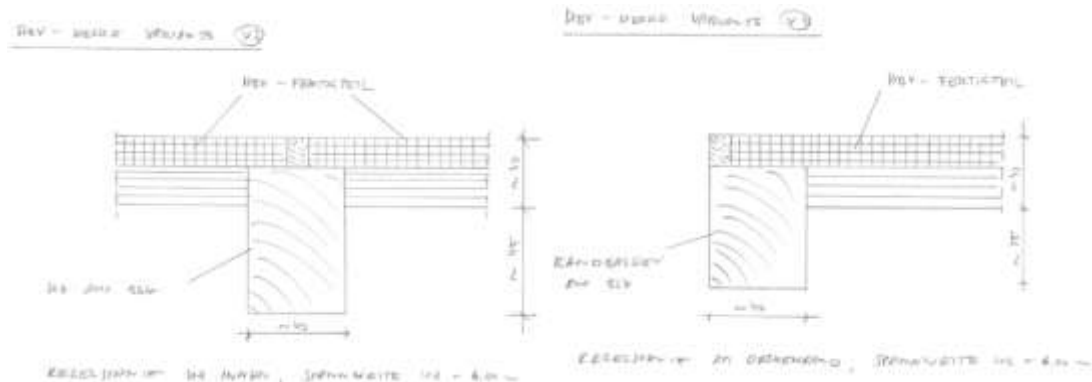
Geschossdecke Variante V2: Brettschichtholz-Unterzug-Direktes Auflager
